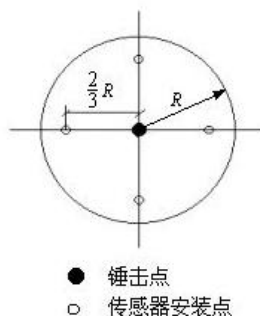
混凝土灌注桩传感器安装点（检测点）、锤击点布置示意图
